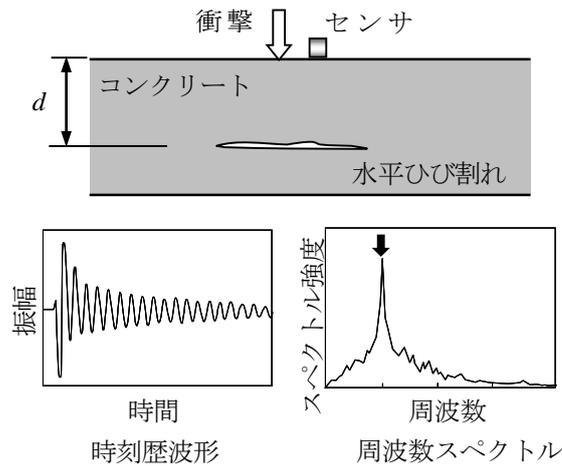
衝撃弾性波法による水平ひび割れの評価原理
